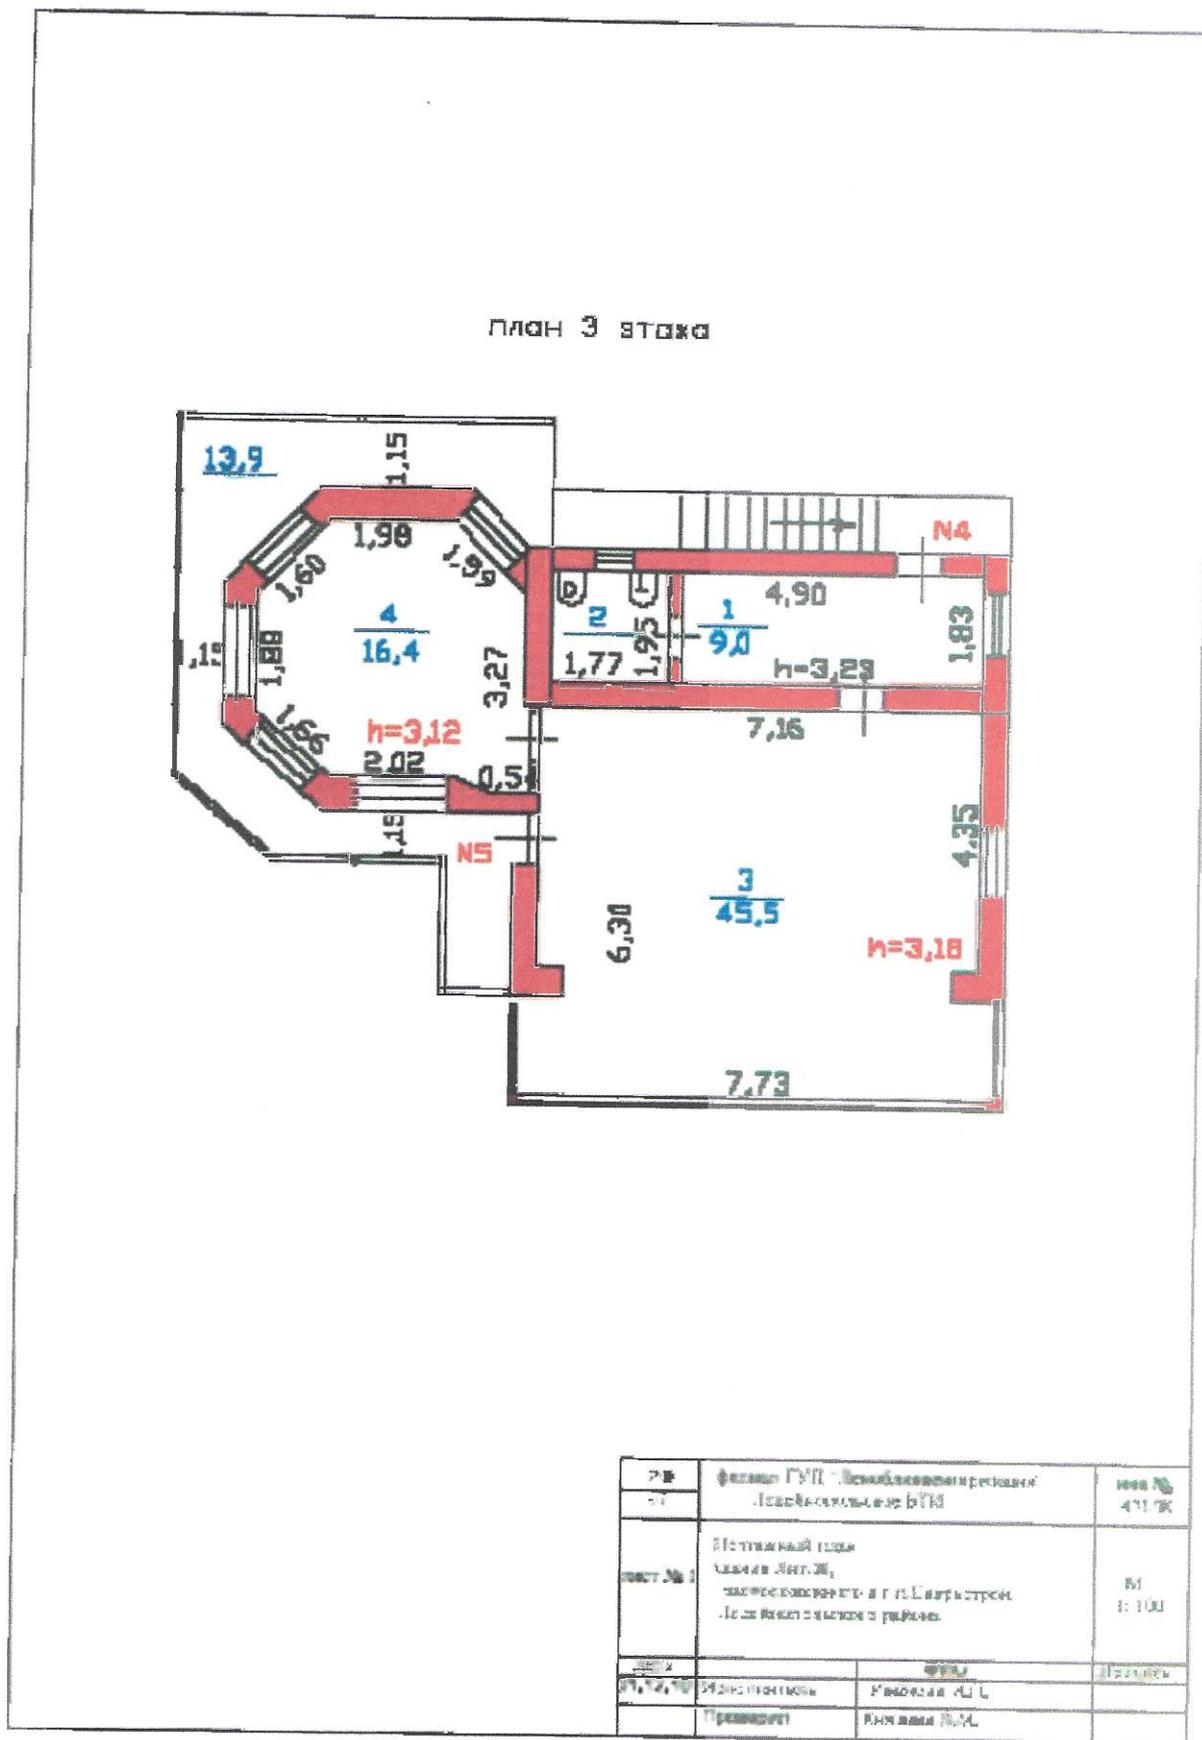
Поэтажный план здания Лит. Ж (3 этаж)
